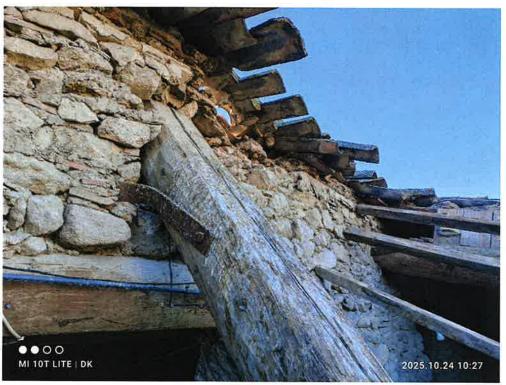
rupture poutre maitresse et descente de poutre au faîtage
